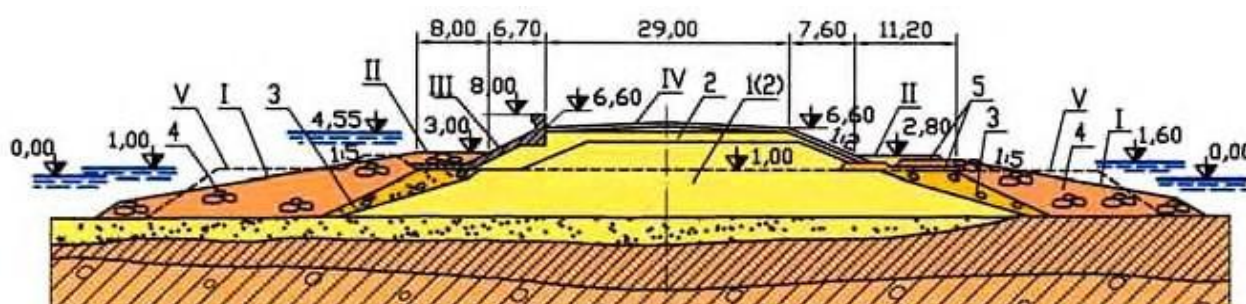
Поперечный профиль каменно-земляной защитной дамбы Санкт-Петербурга от наводнений: I – пологий динамически устойчивый откос; II – волногасящая берма; III – железобетонные плиты крепления верхового откоса; IV – железобетонная волноотбойная стенка; V – поперечный профиль первоочередной отсыпки скального грунта; 1 – мореный суглинок полезных выемок; 2 – песчаный грунт; 3 – переходной слой из песчано-гравийного грунта; 4 – горная масса; 5 – щебень
